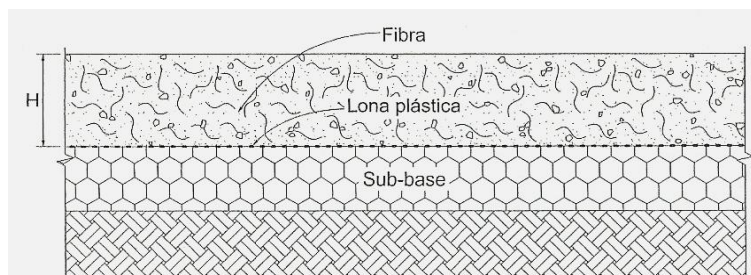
Seção transversal: Pavimento de concreto reforçado com fibras
